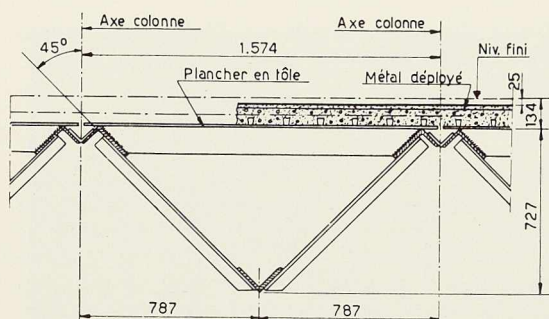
Bâtiment des bureaux. Détails constructifs des poutres triangulées (coupe A-A de la figure 12).
